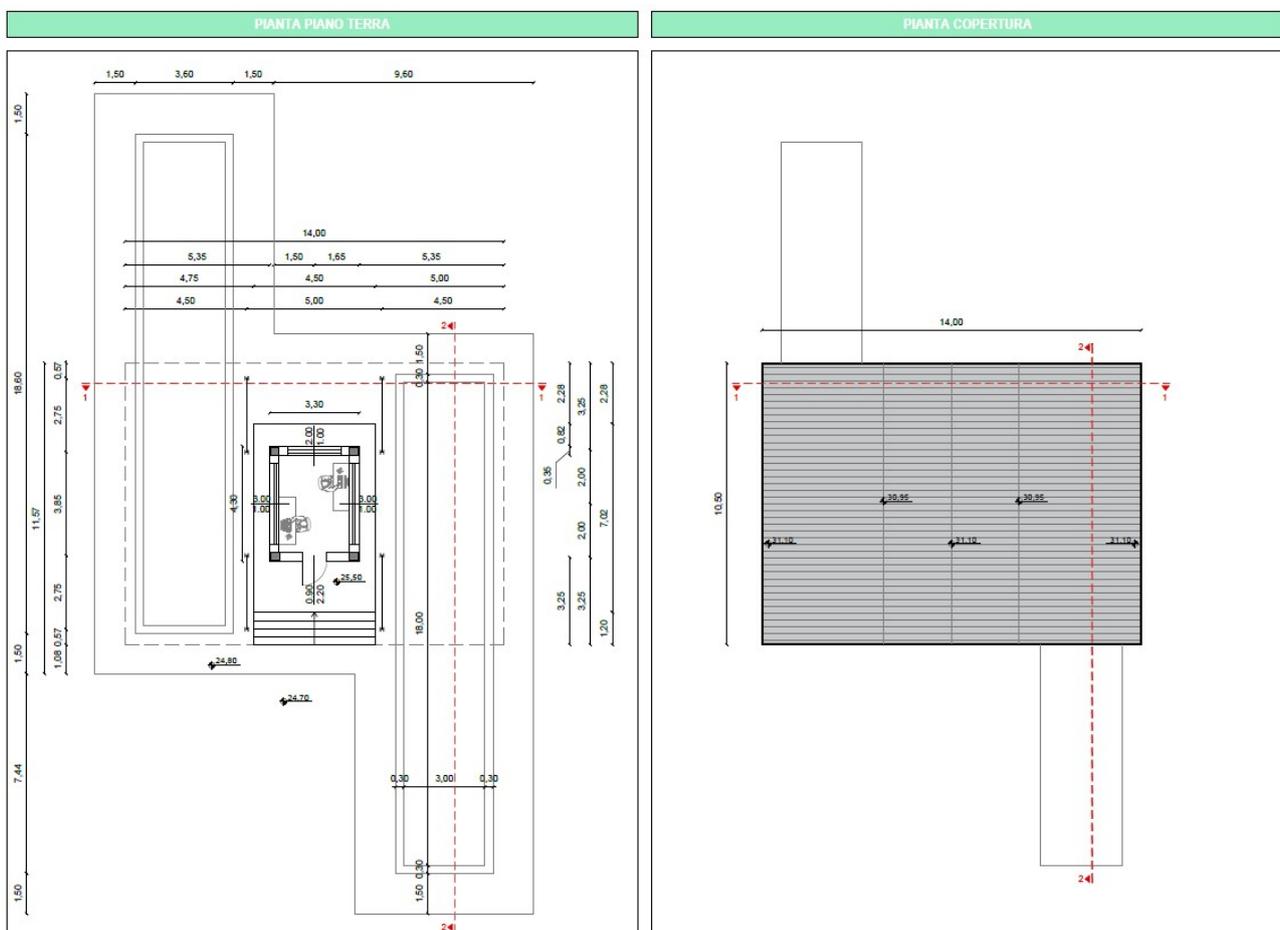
Pianta piano terra e pianta copertura della nuova area di pesatura
